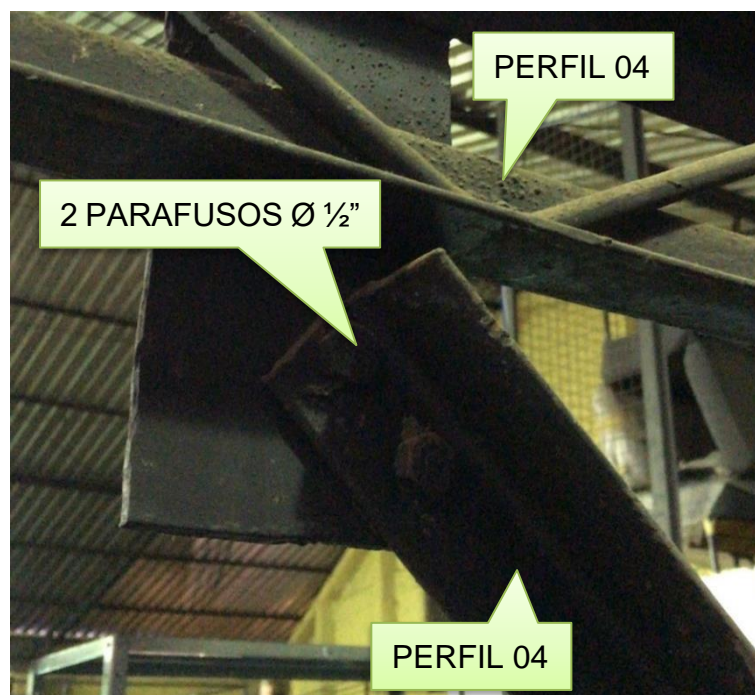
LIGAÇÃO NO TRAVAMENTO
